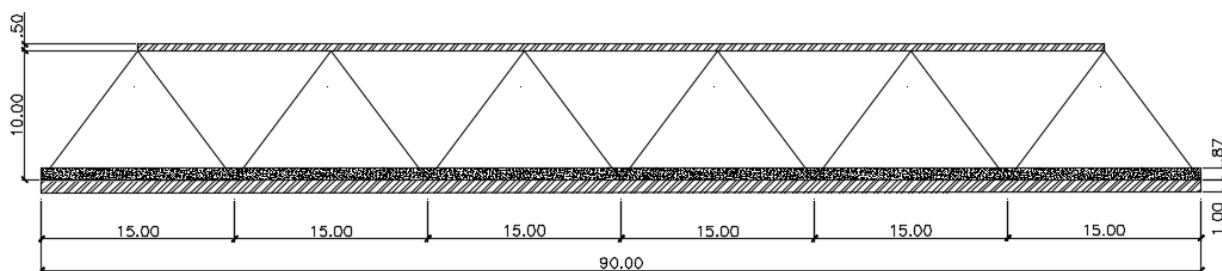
Seção Longitudinal Ponte Metálica Treliçada
